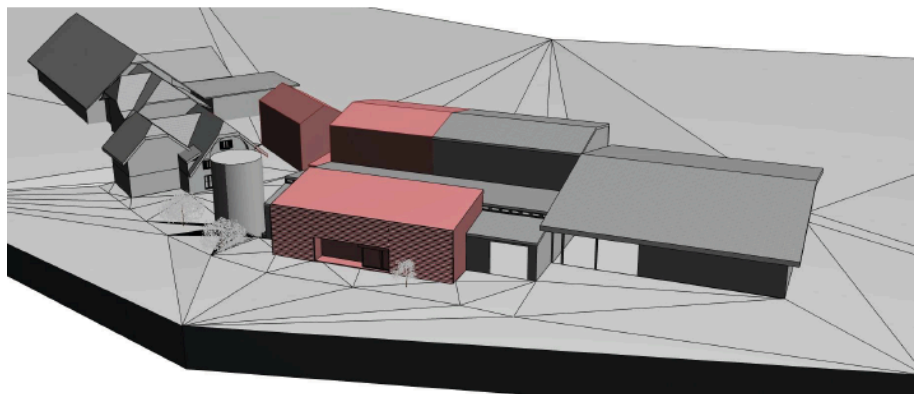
Visualisierung des Projekts. Ergänzungsbauten und Ersatzneubauten rot markiert.
